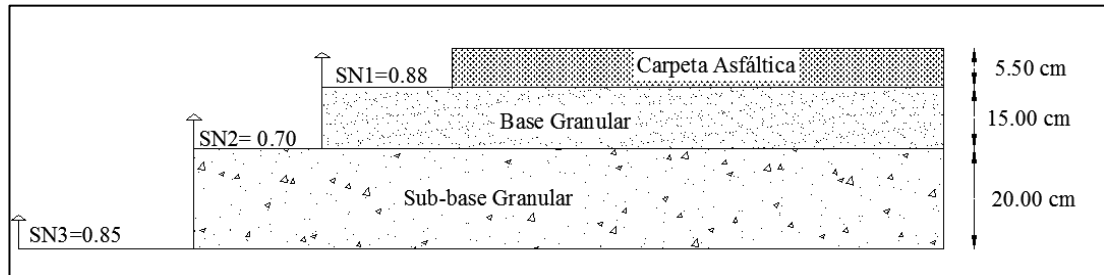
Espesor de las capas del pavimento diseñado con CBR de laboratorio
